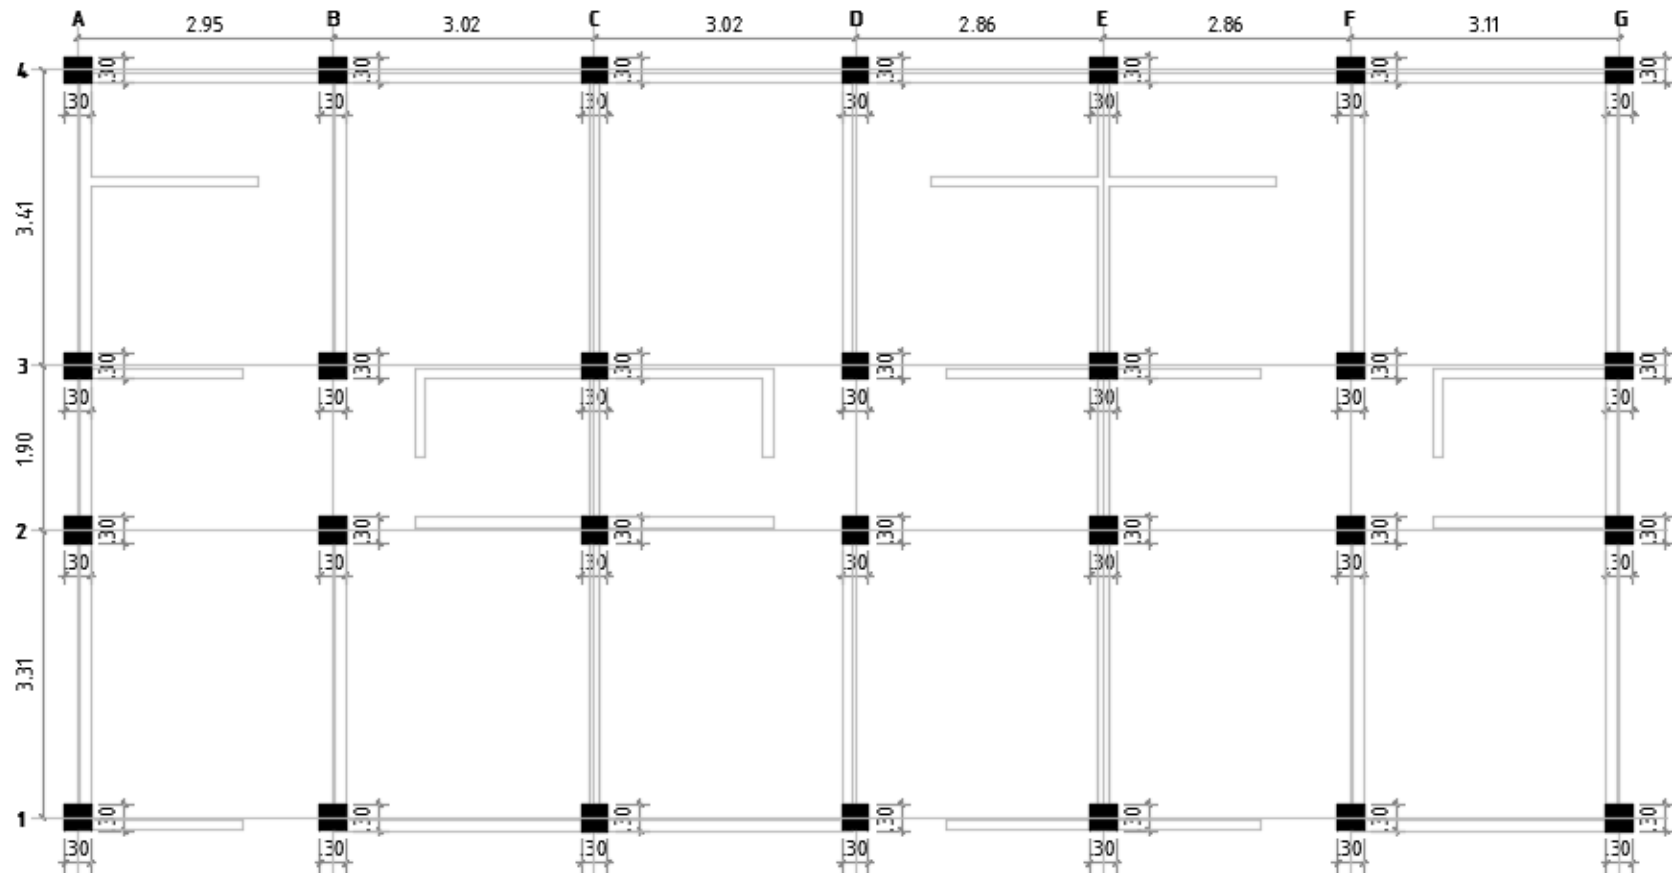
Replanteo en sistema tipo pórtico de viviendas de un piso
